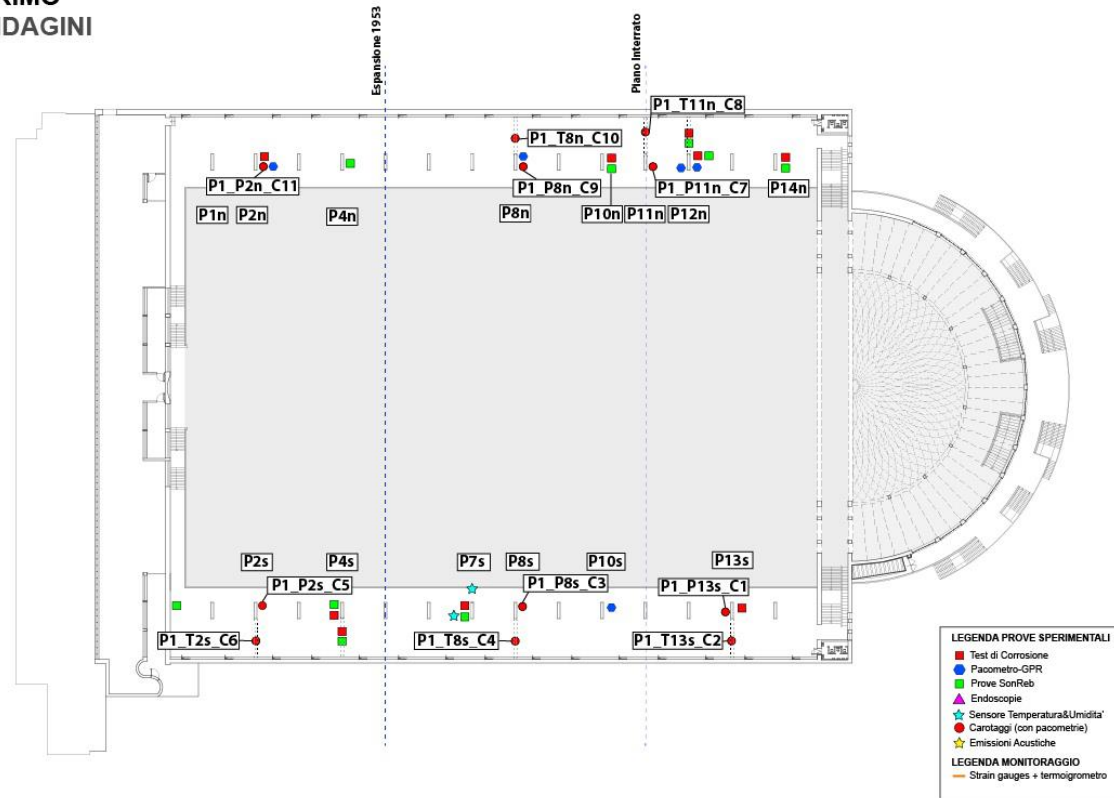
Planimetria riportante il piano prove del piano 1 (balconate)
